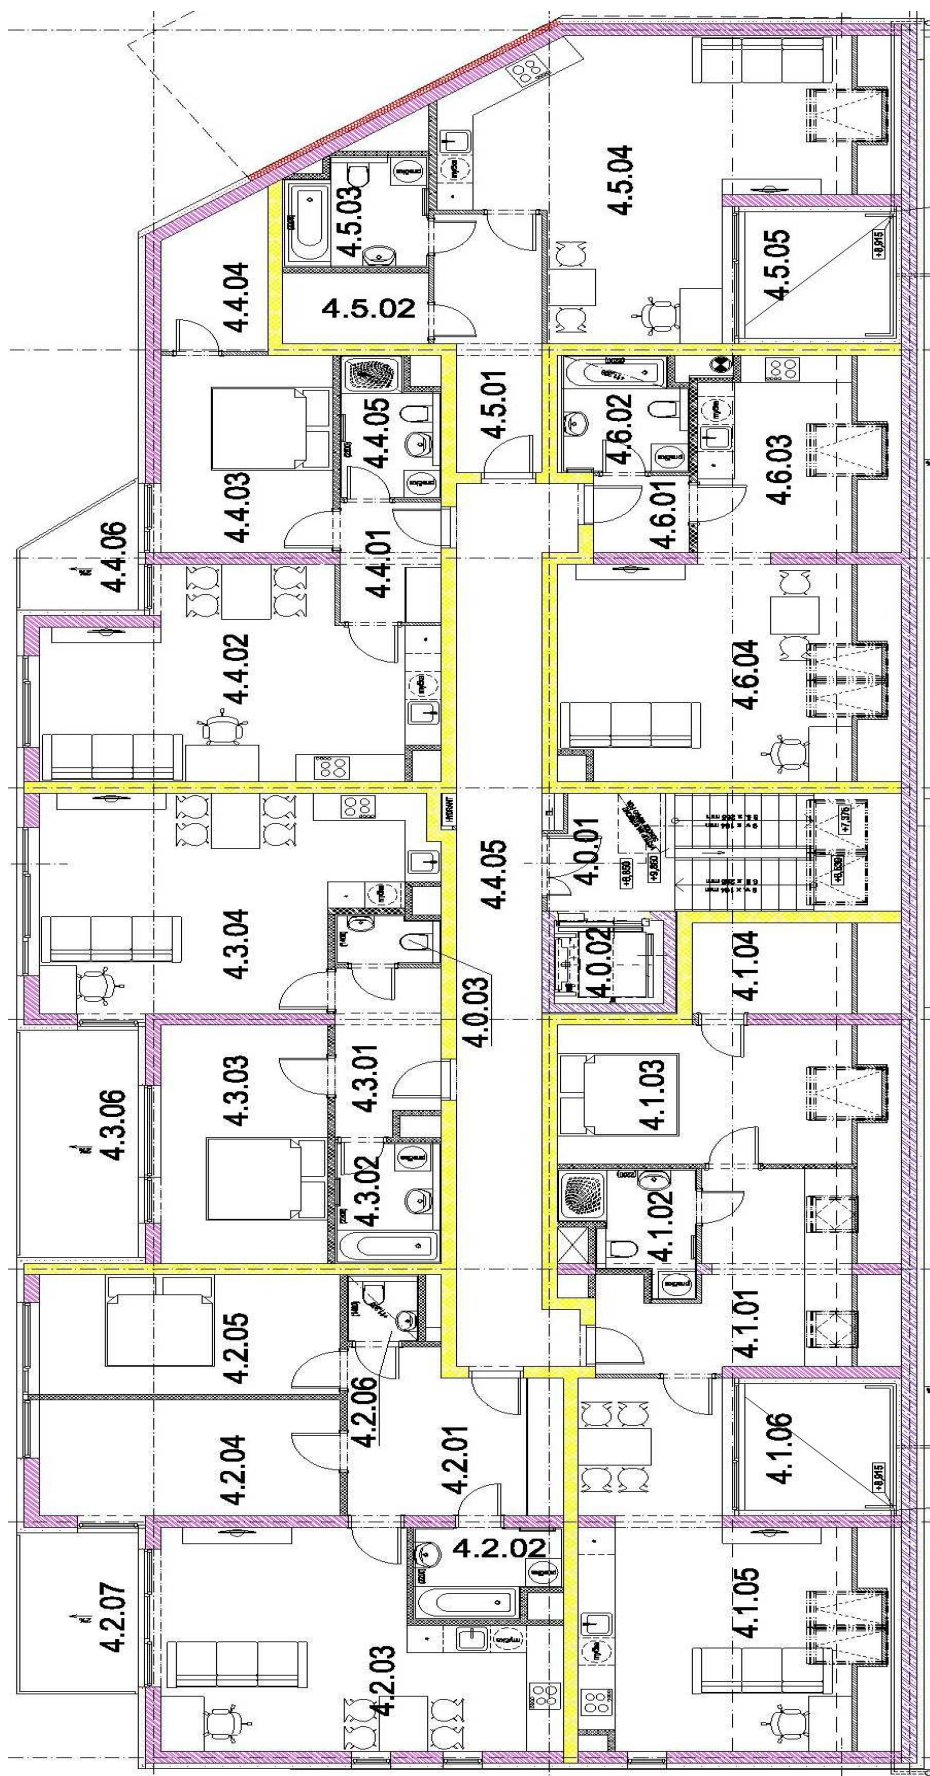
Schematické dělení svislých konstrukcí 1.NP
